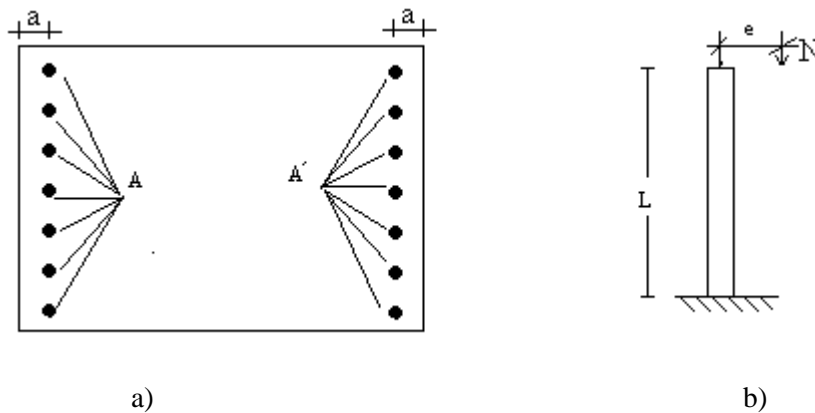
a) Geometria da secção transversal do pilar. b) Alçado do pilar e posicionamento da carga.
